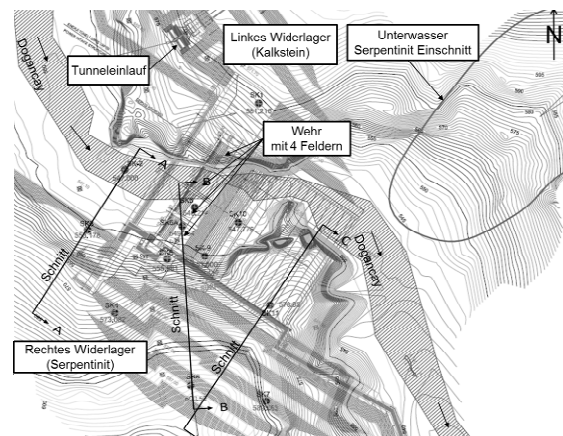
Lageplan der Wehranlage (Schnitt A-A, B-B, C-C) mit Bohrungen
